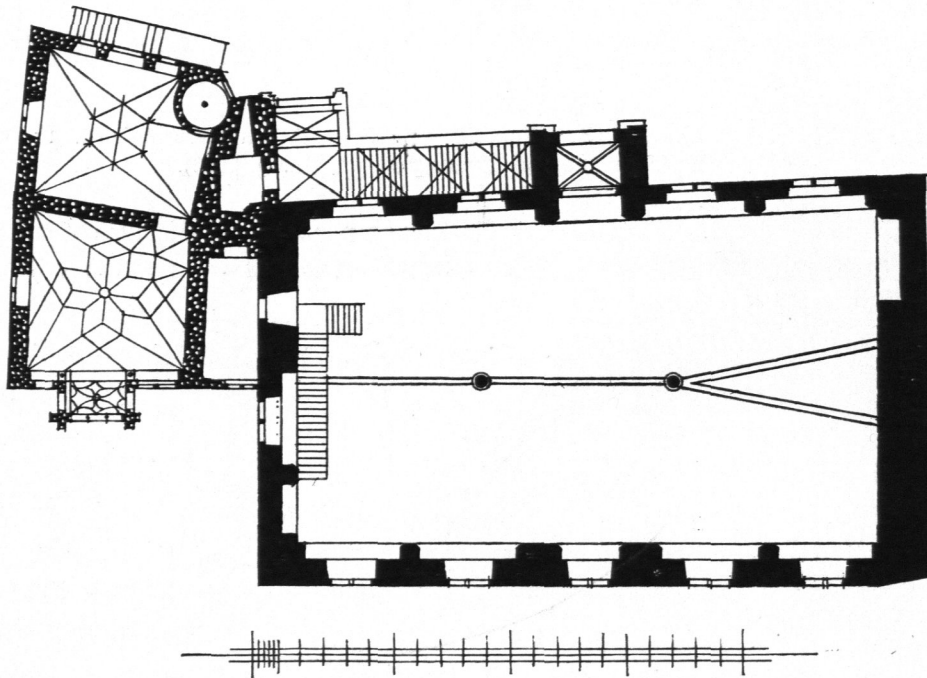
Rathaus zu Koblenz. Grundriß im Erdgeschoß.
